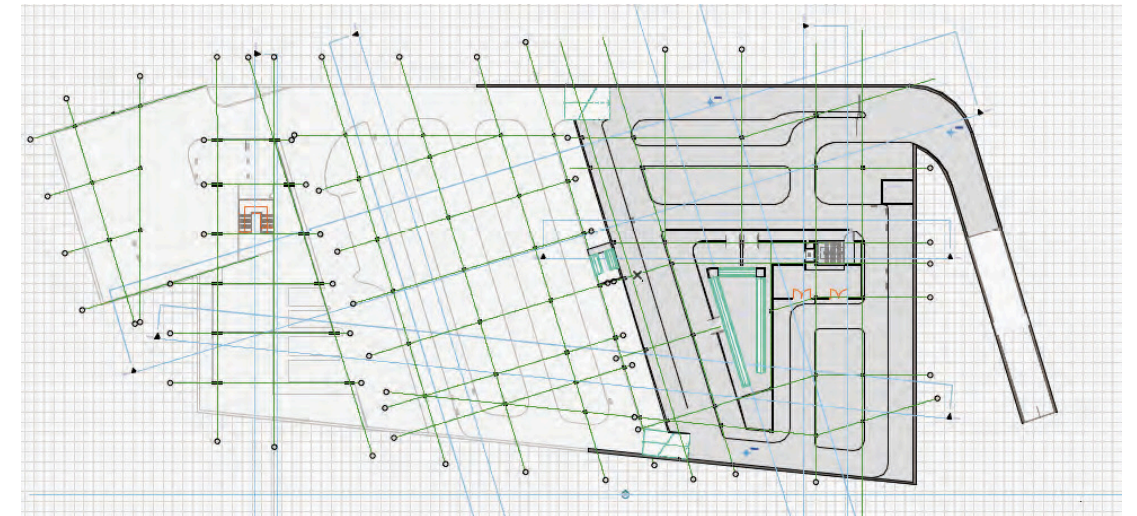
Planta ejes estructurales, fuente: esta investigación
